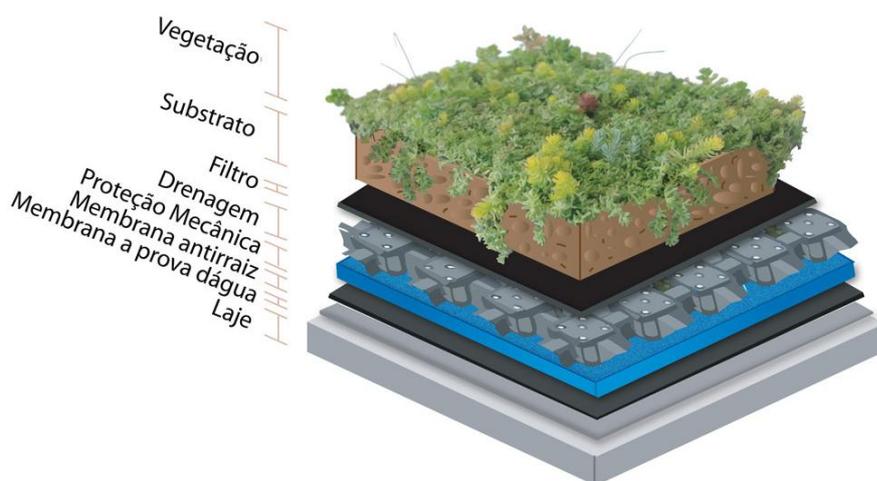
Componentes do telhado verde (Fonte: internet ¹¹)
